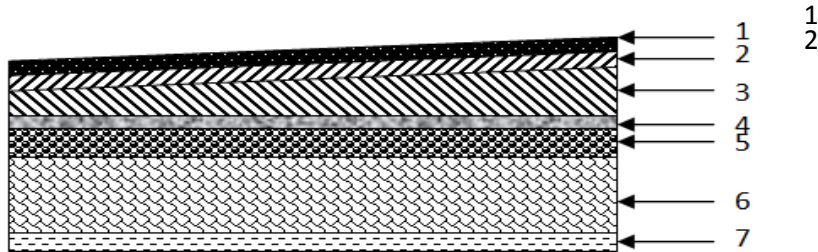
Coupe transversale du plancher terrasse inaccessible.
